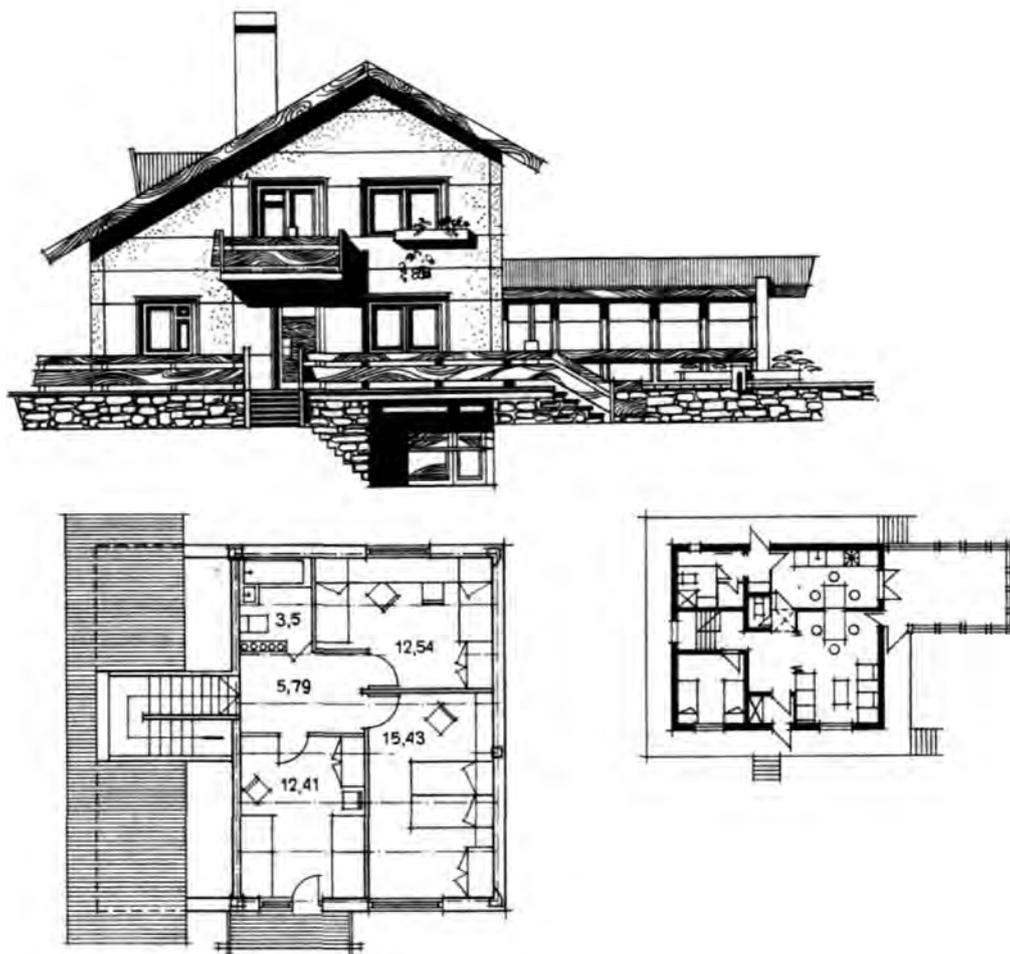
Пятикомнатный двухэтажный дом с неполным верхним этажом. Фасад, план второго этажа (слева), план первого этажа (справа)
